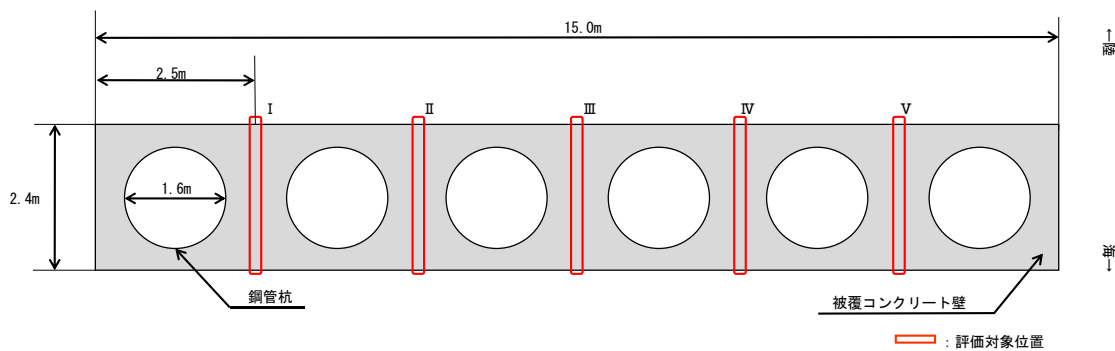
(1) 評価対象位置図(②-②断面, 平面図)
